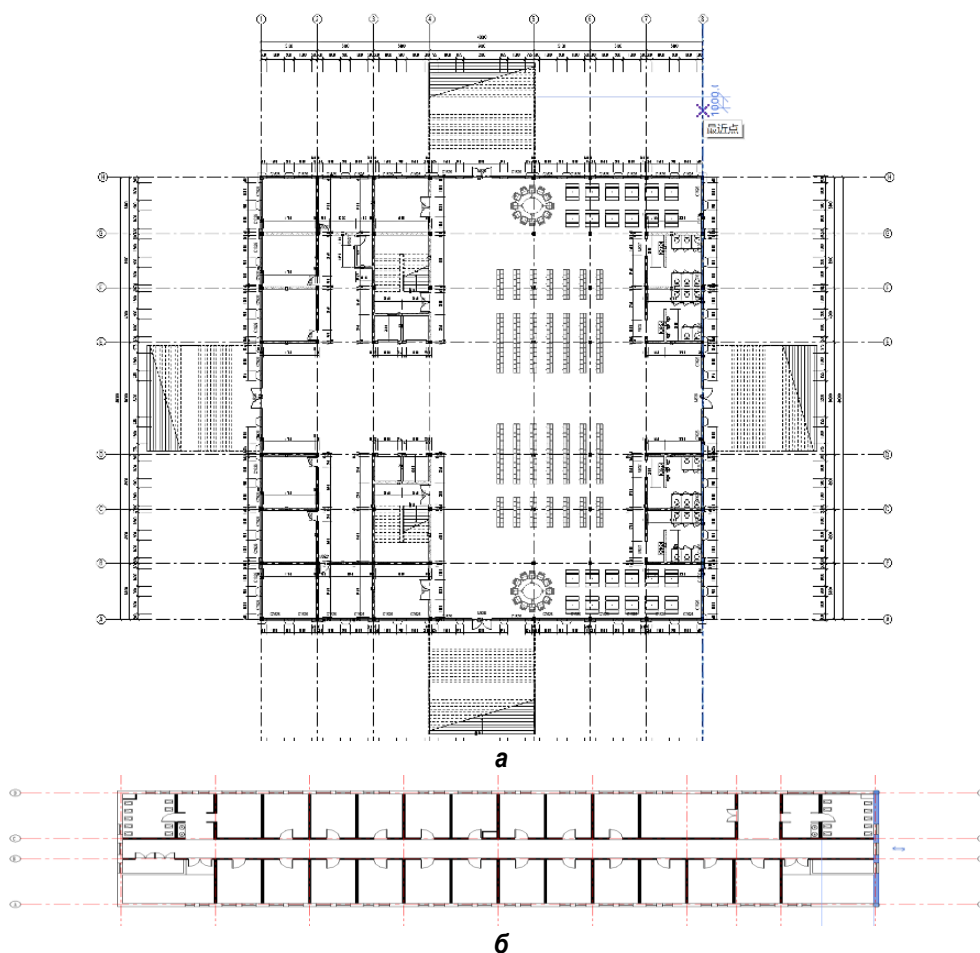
Планы этажей: а – здание библиотеки; б – здание общежития
